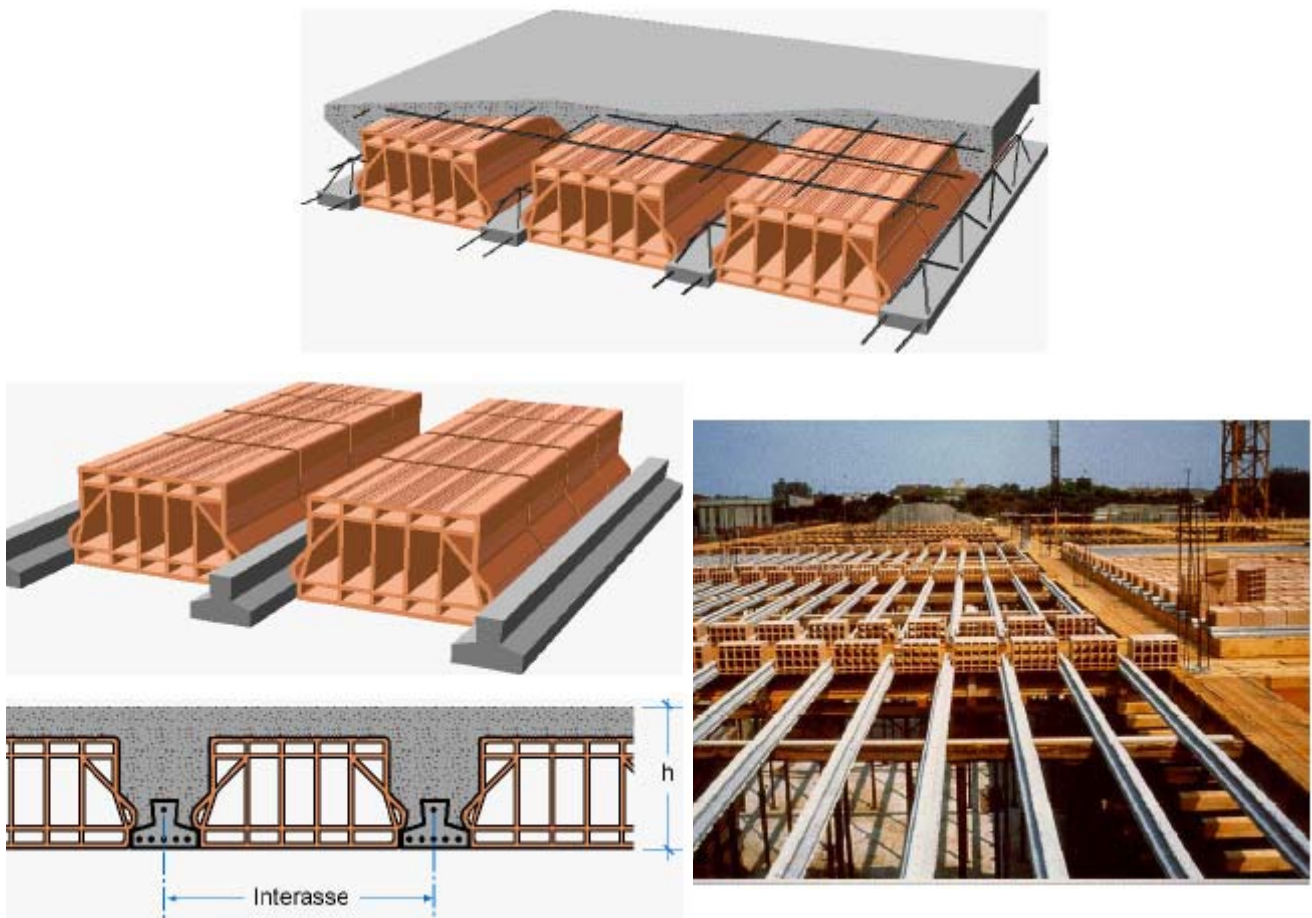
Solai in c.a. con travetti prefabbricati
